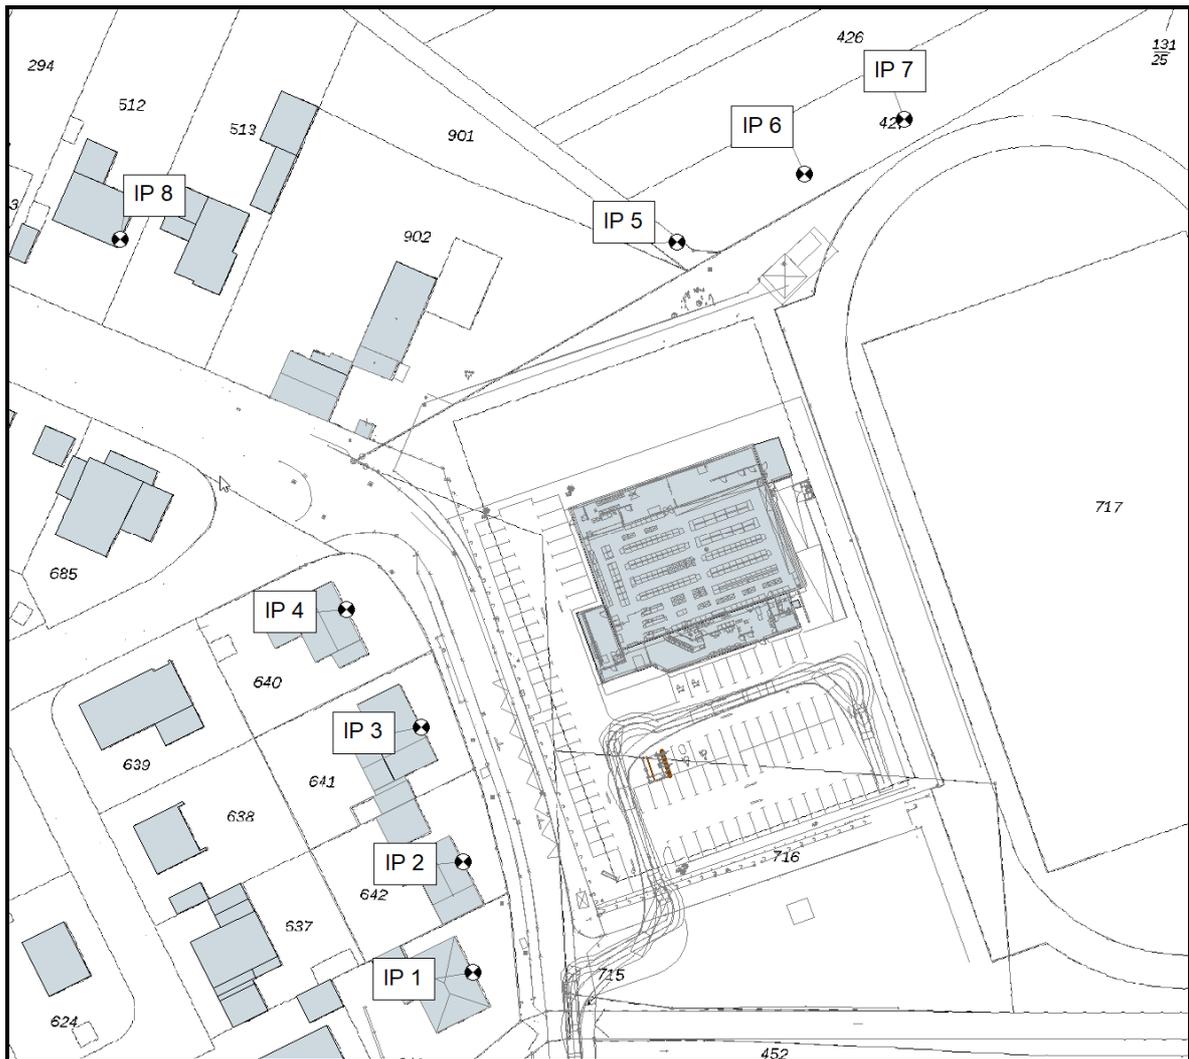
Lageplan mit Kennzeichnung der Immissionspunkte
